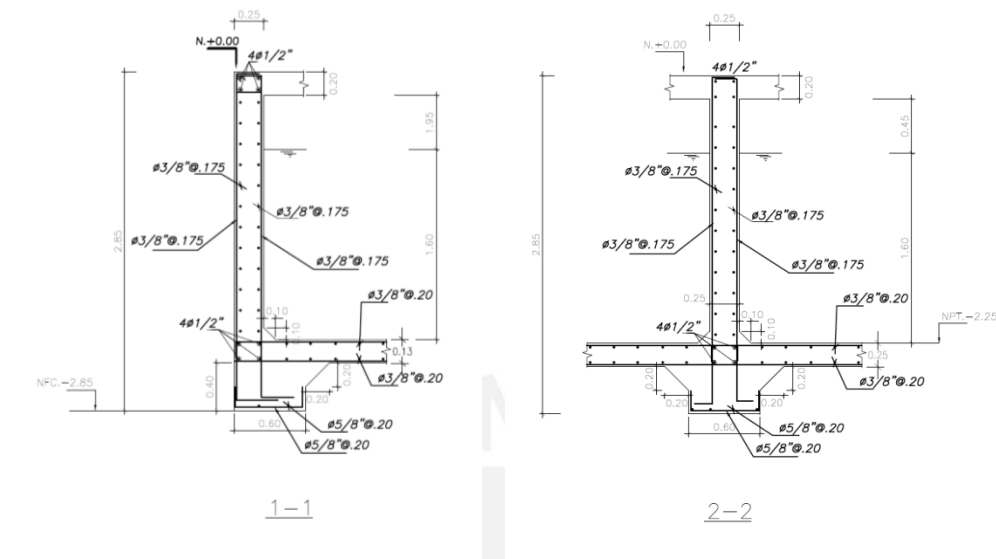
4 Distribución del acero para los muros y la losa de la cisterna
